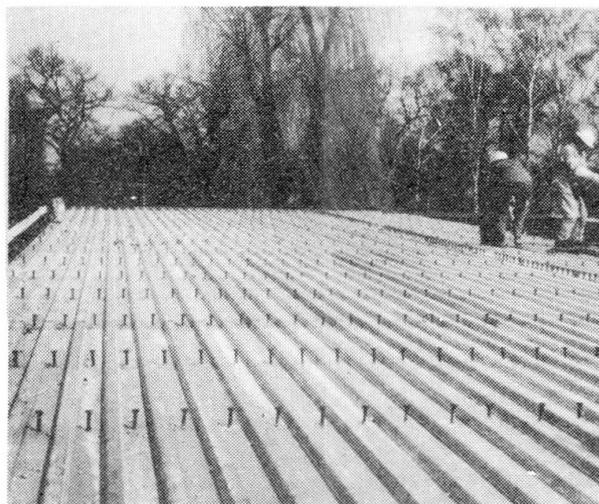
Deckenkonstruktion des VIP Systems mit verschweissten Kopfbolzendübeln
